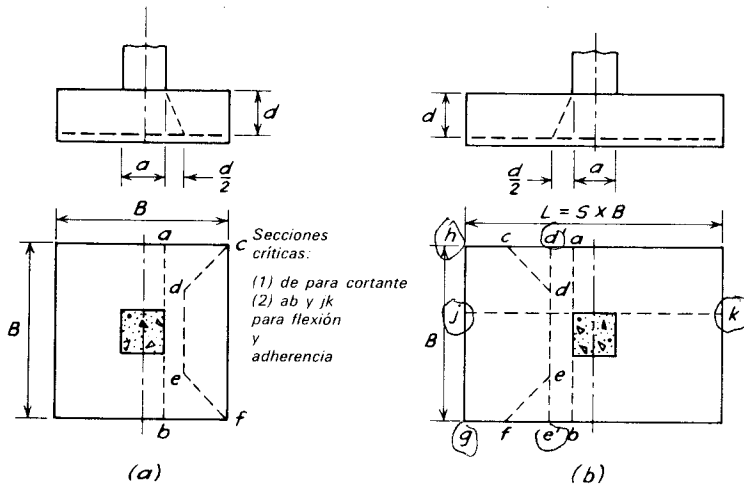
Secciones críticas para cortante, flexión y adherencia del refuerzo en a) zapatas cuadradas y b) rectangulares.
